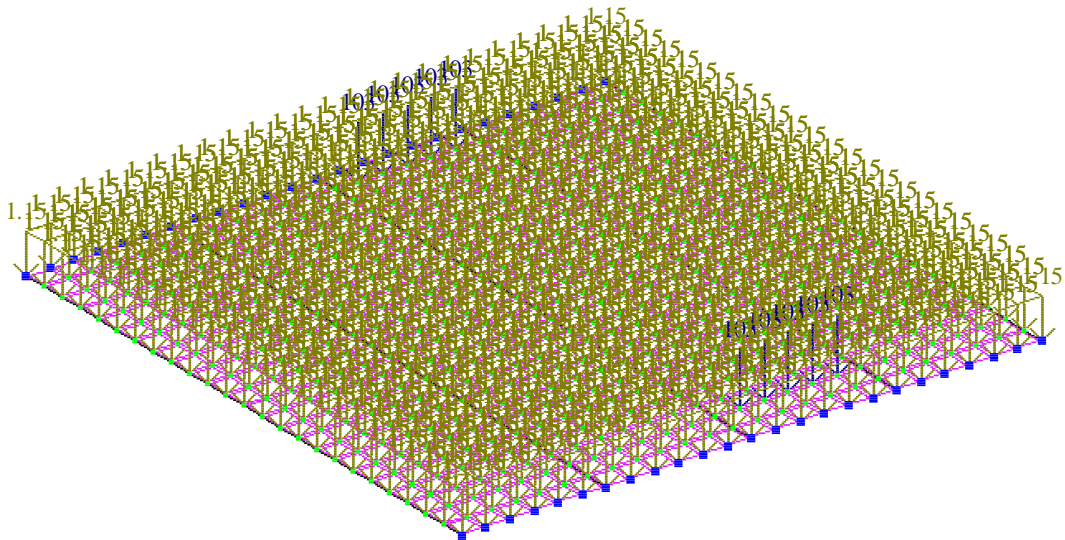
Расчётная схема плиты от технологической нагрузки деаэрационного оборудования
